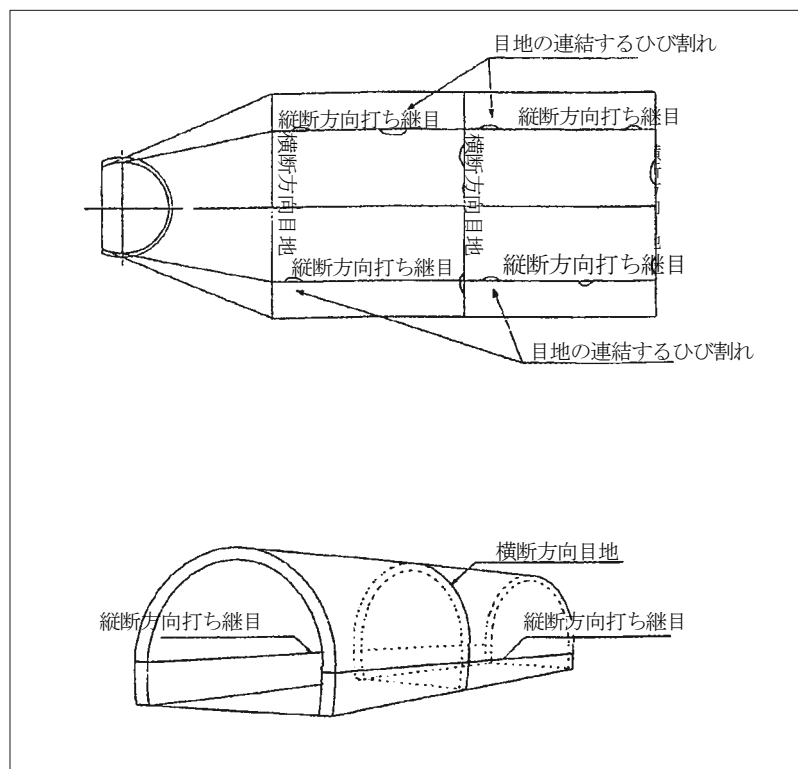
覆工コンクリートの目地と継目付近のひび割れ
